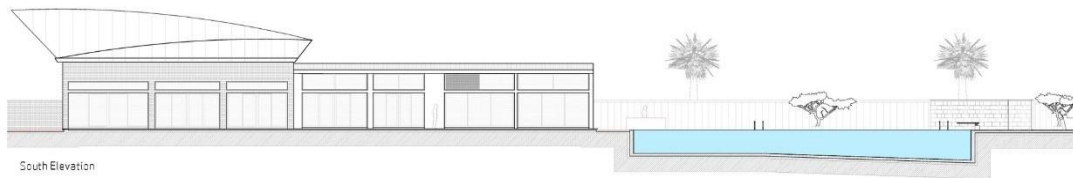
Vista da fachada posterior da Inspire Pure Fitness, elevação sul, evidenciando os panos de vidro usados no projeto. Fonte: Site Archdaily (2019).
